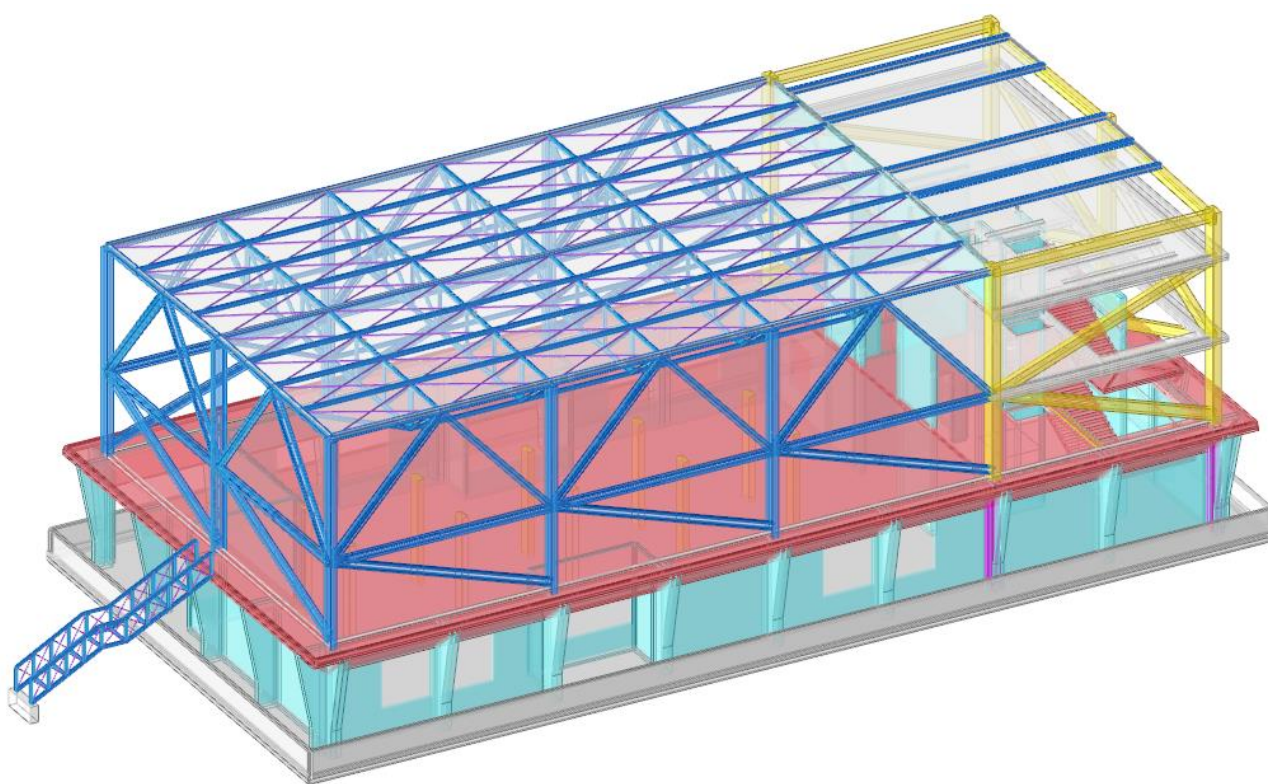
Vista 3D del Modello Strutturale FEM – Corpo A – Vista Assonometrica – Stato di Progetto
